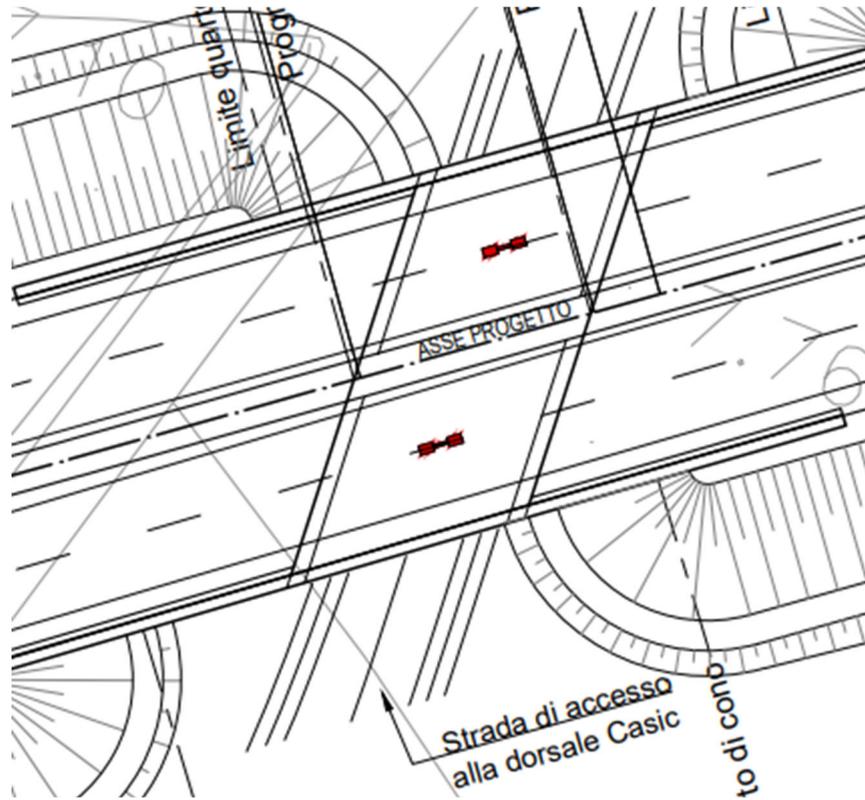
Ubicazione sensori su scatolare (Pianta ST01)
